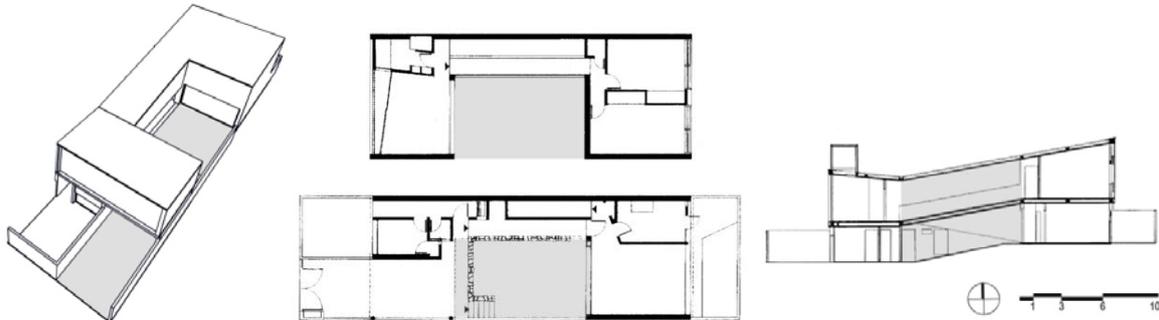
, 19 e 20: planta baixa, maquete e perspectivas interna da casa Castor Delgado Perez, São Paulo, 1954, Rino Levi
